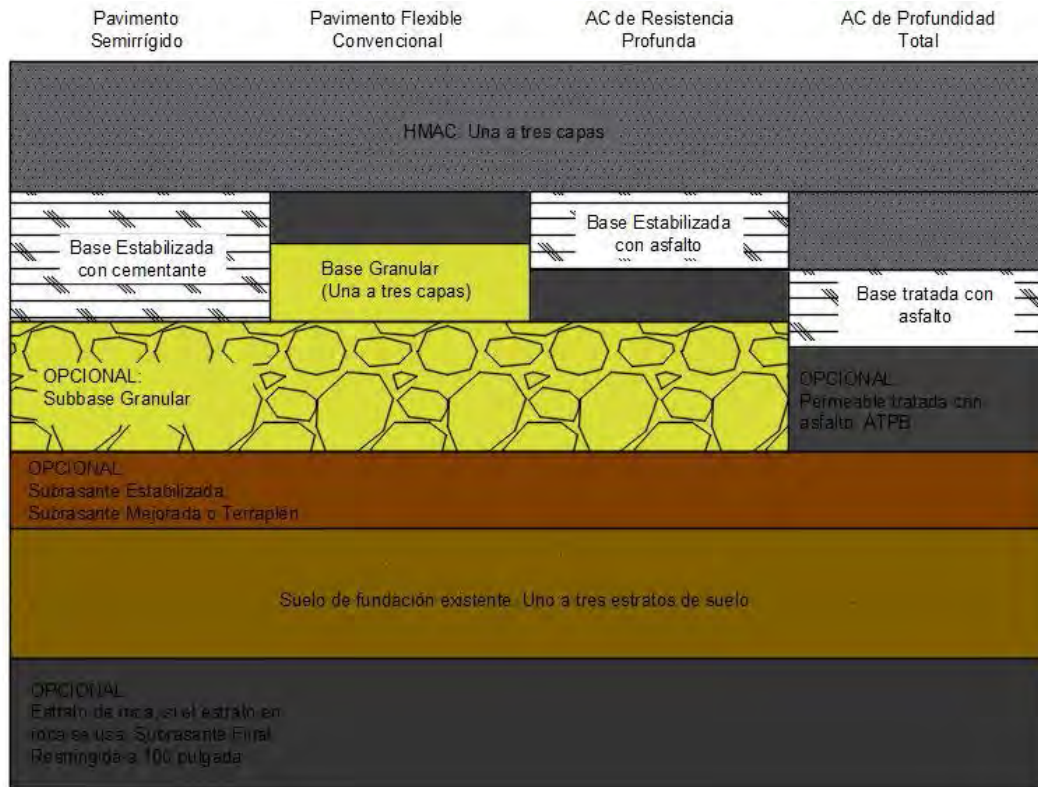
Estructuras de pavimento flexible nuevo en el MEPDG.
